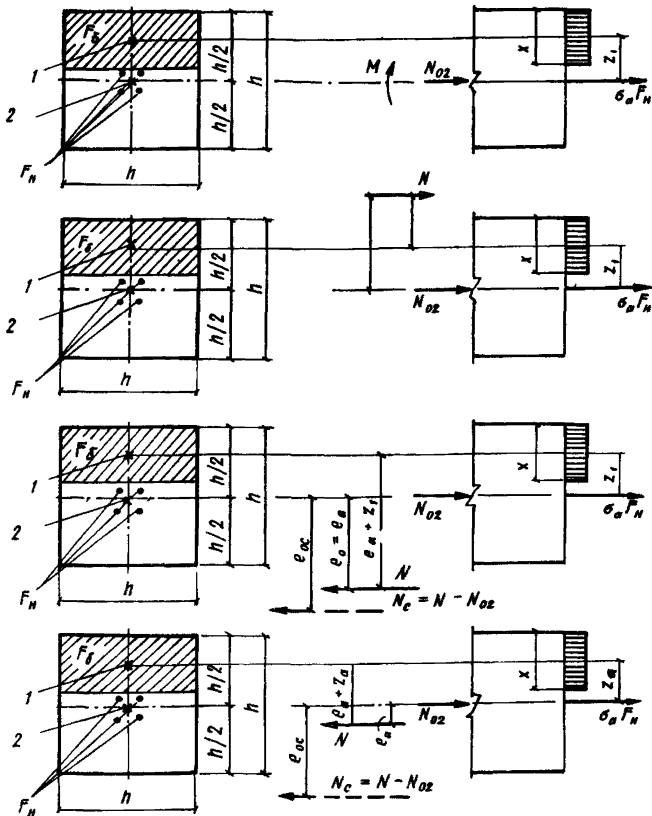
Схема усилий и эпюра напряжений в поперечном сечении сваи при его расчете по ширине раскрытия трещин, нормальных к продольной оси сваи
